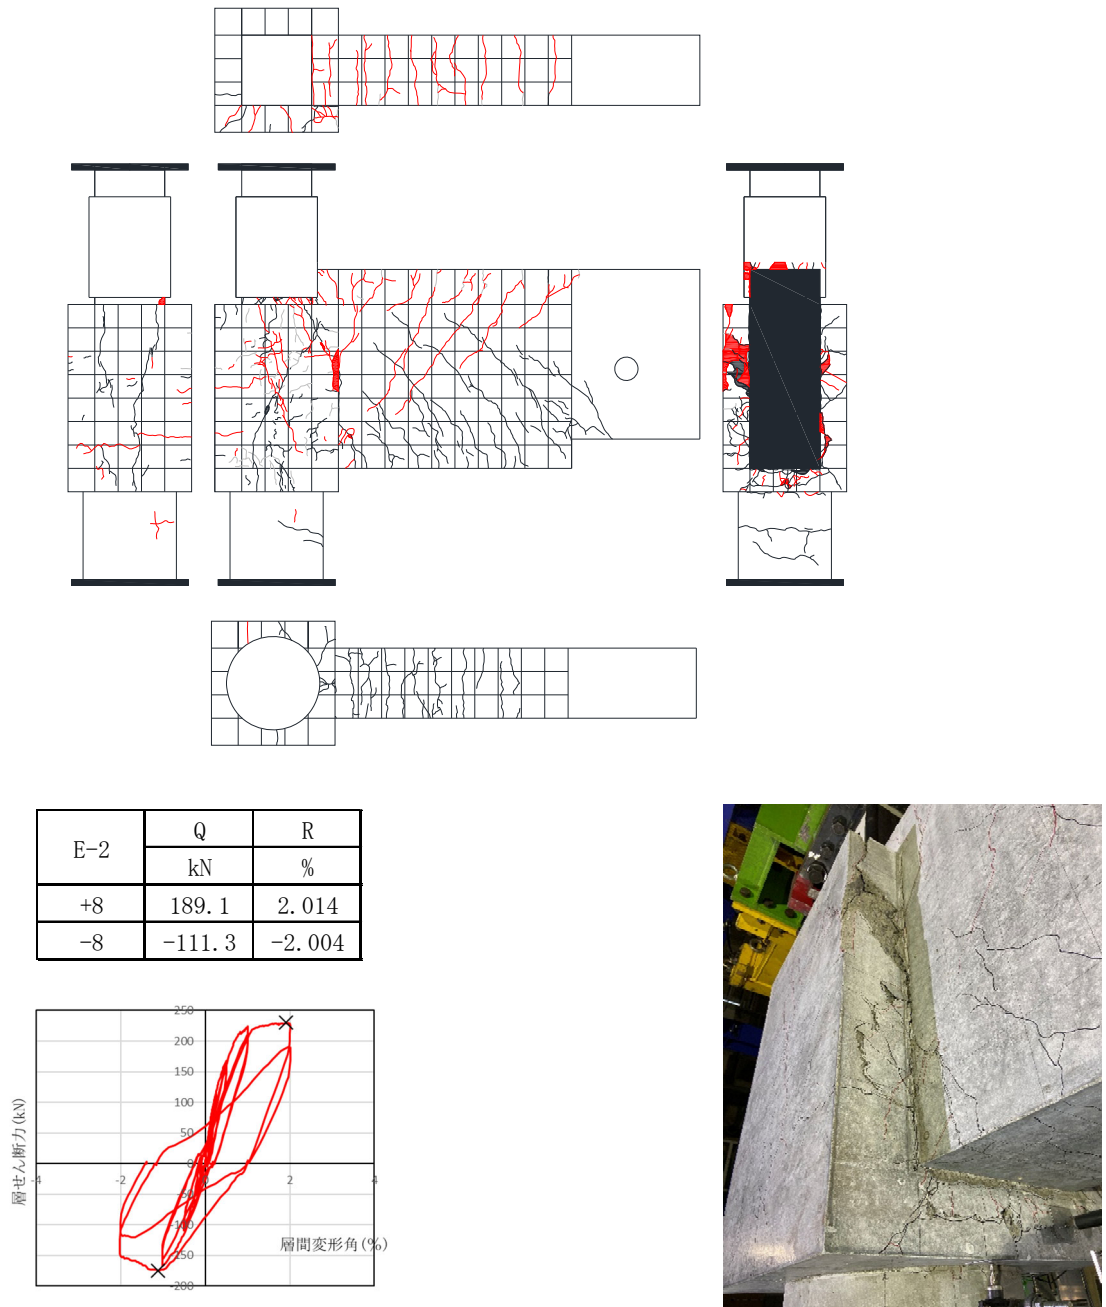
3. 2-15 E-2 ひび割れ状況 (5Cycle)
